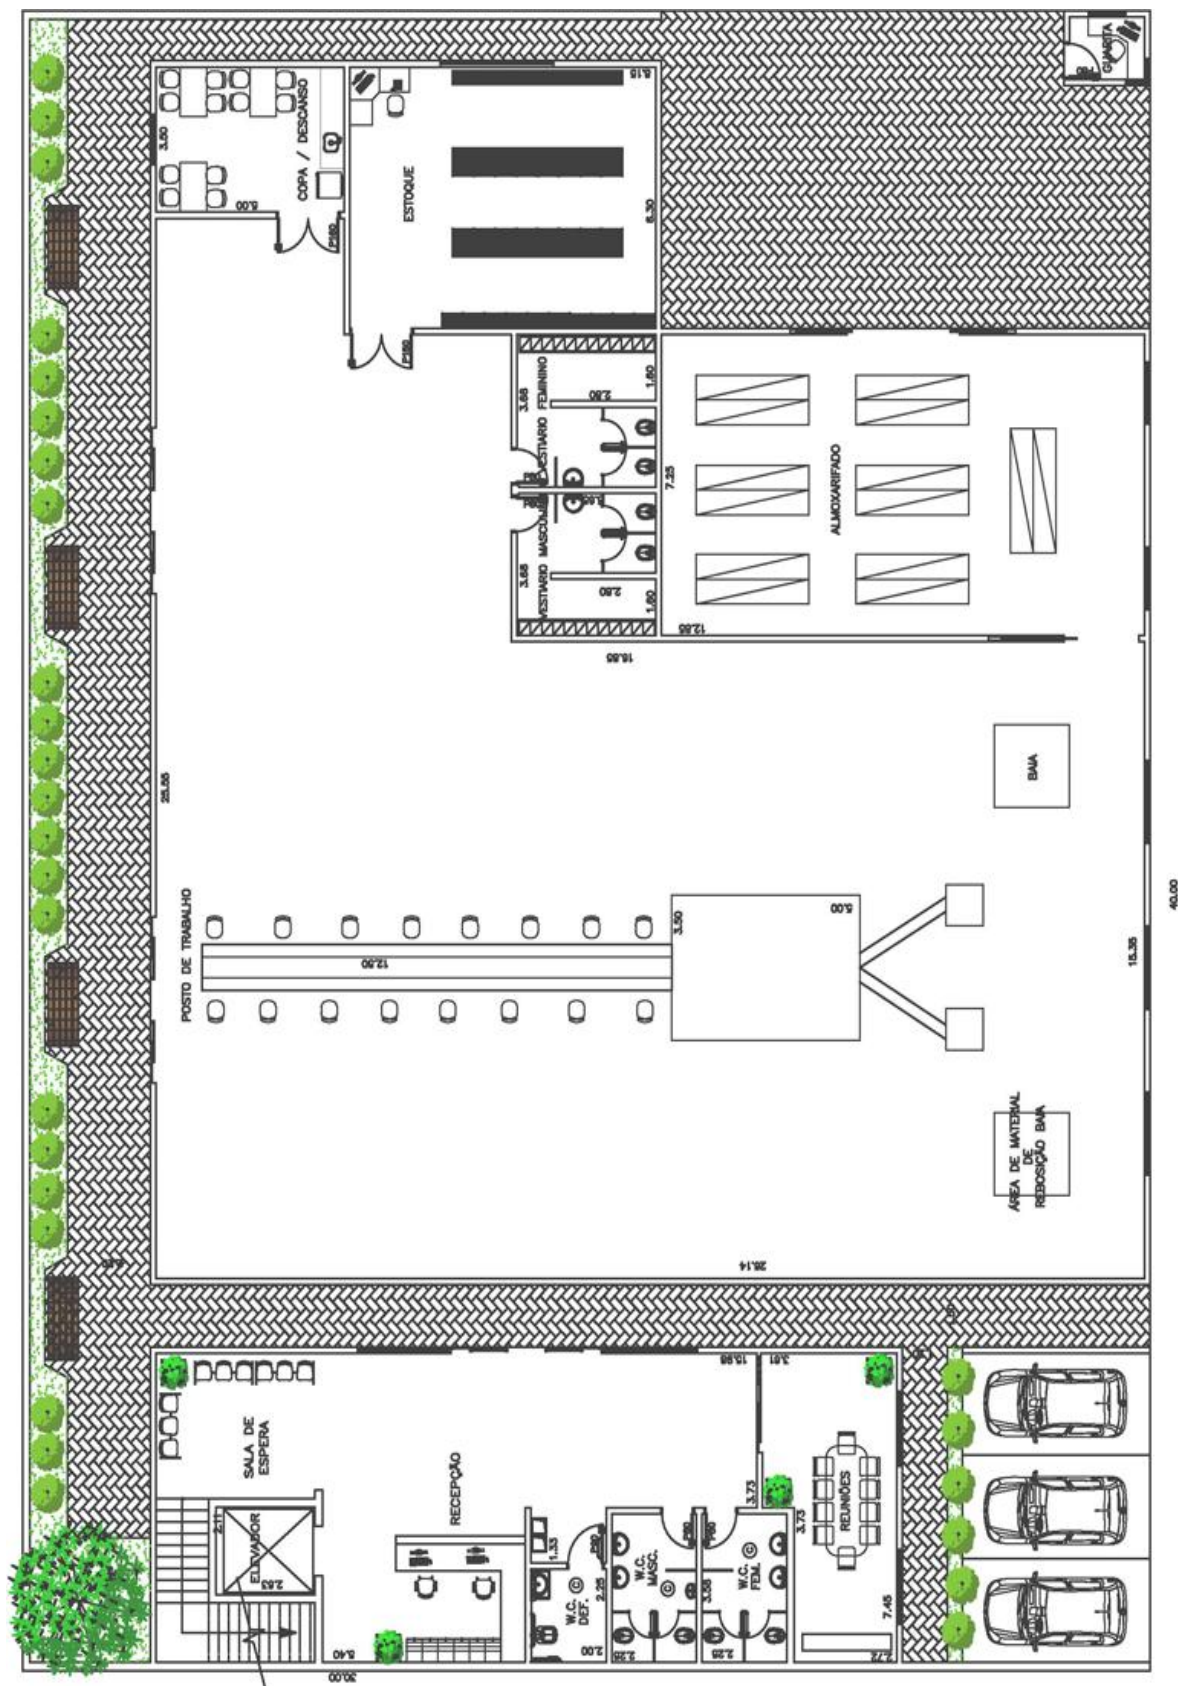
Planta da Fábrica (Pavimento Inferior)
